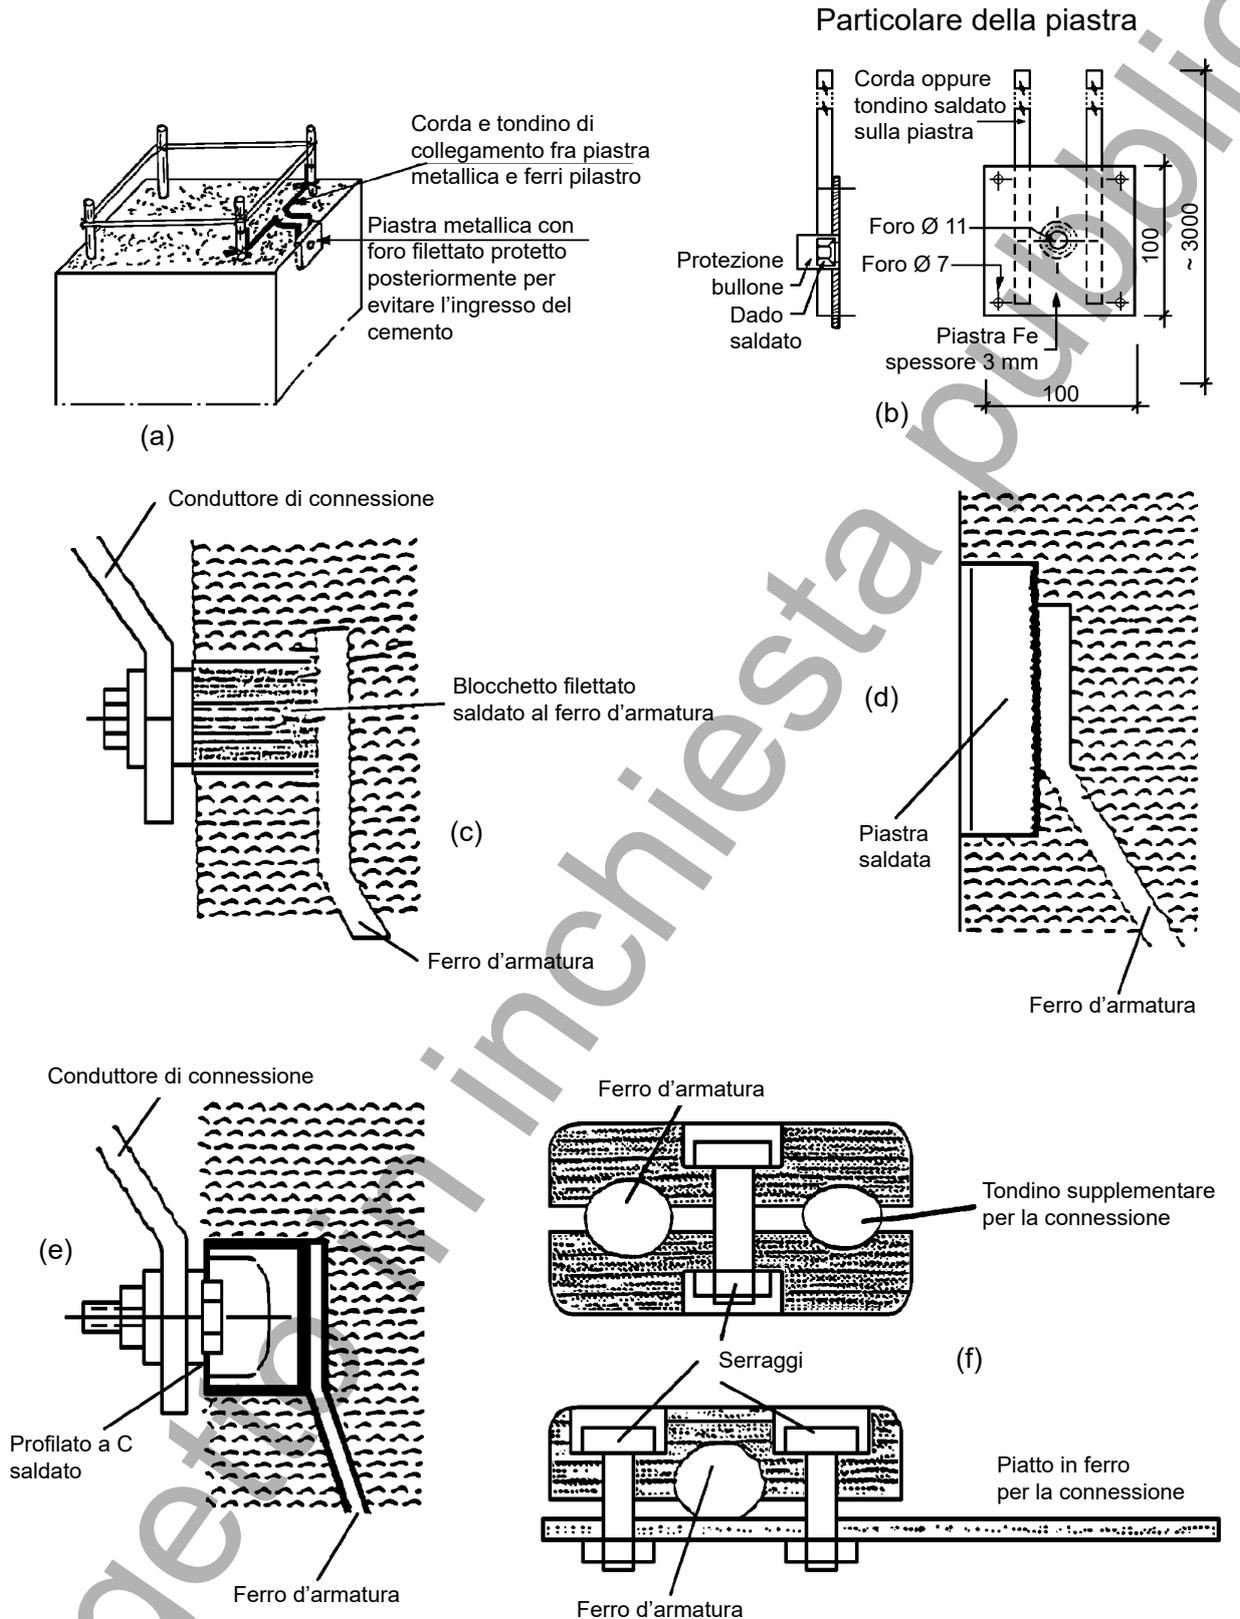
Esempi di collegamento ai ferri del pilastro o del plinto con piastra metallica (o con altri elementi metallici) incorporata nel getto del calcestruzzo, particolarmente adatti per elementi prefabbricati
